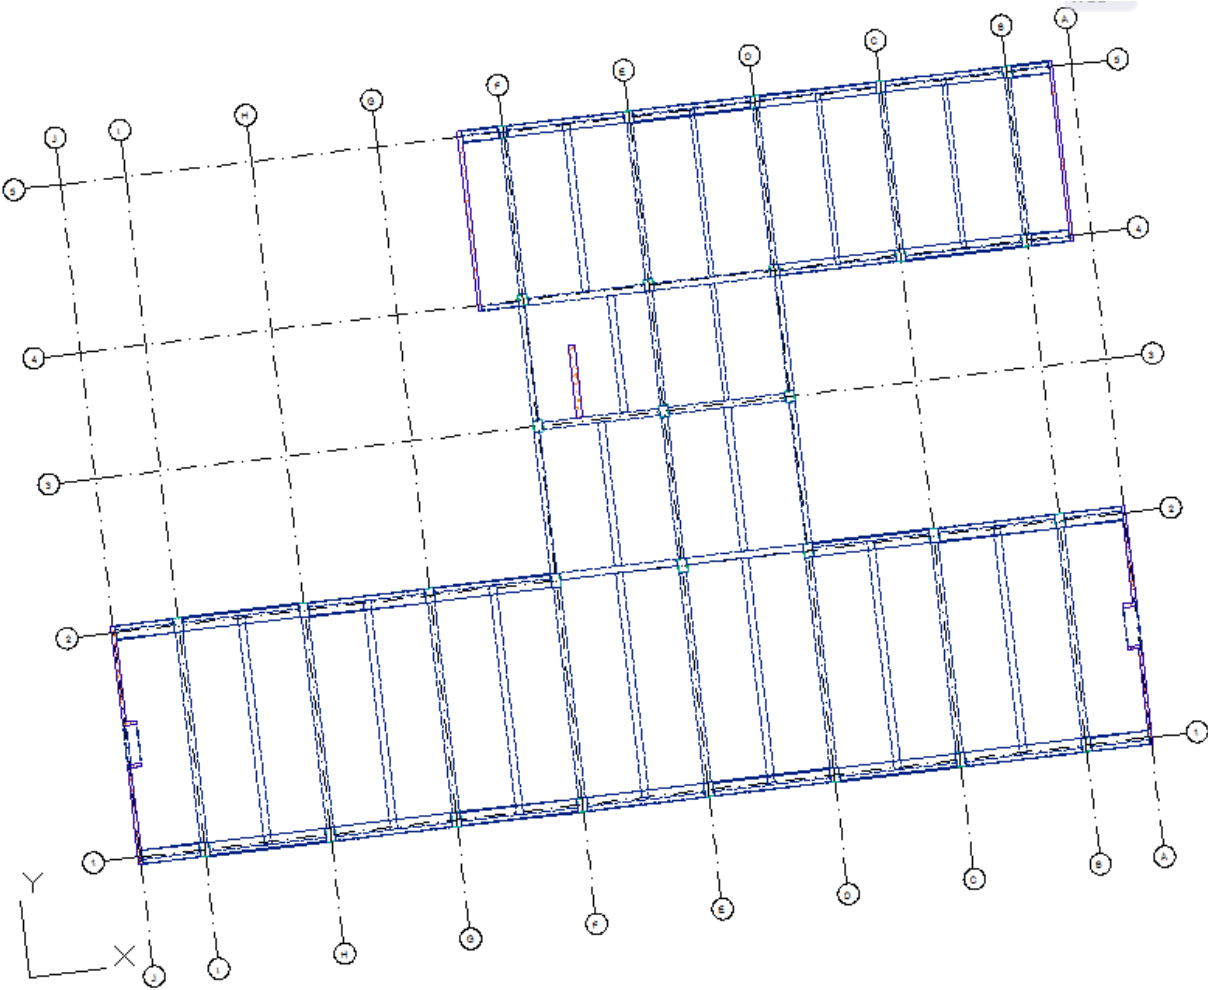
Vista en 2D, en Planta del Nivel 1
